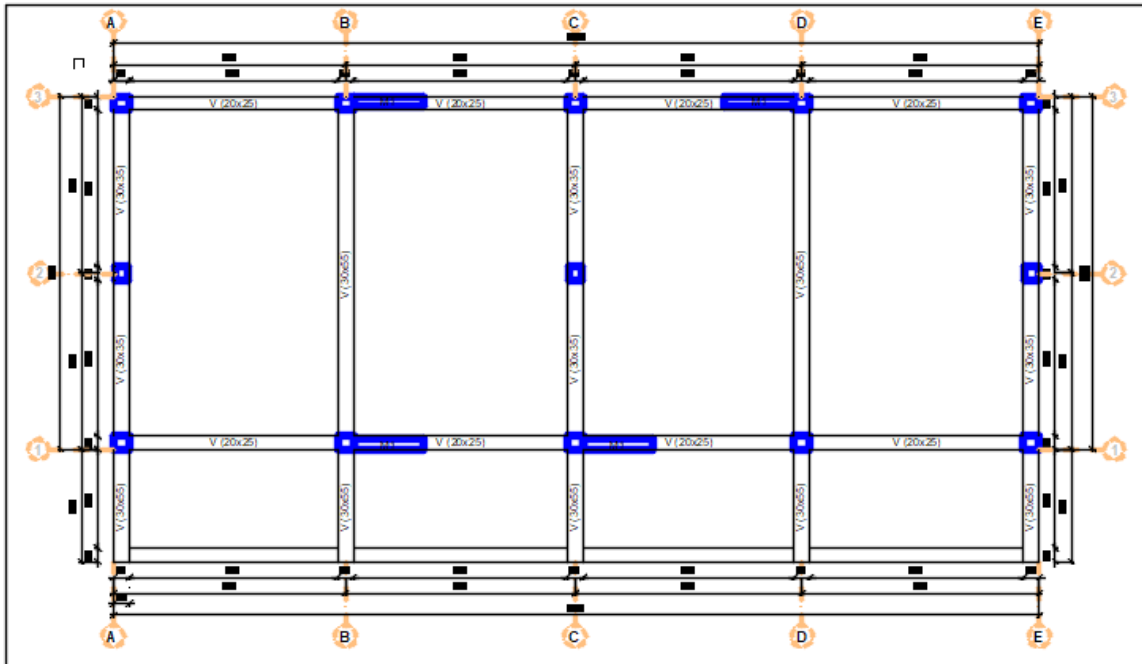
Ubicación de Muros de Corte proyectados para rigidizar la estructura (Módulo B)
